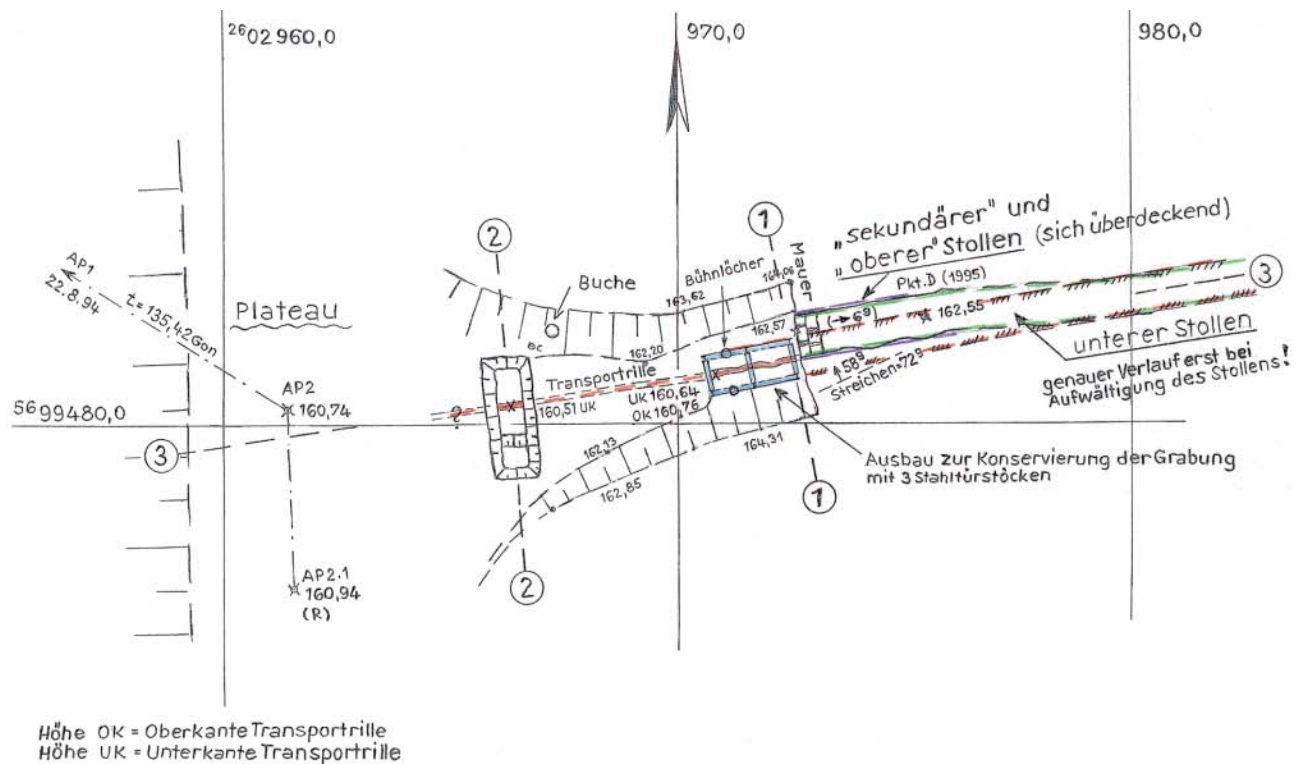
Grundriss der Grabung „Fuchsbaustollen“
